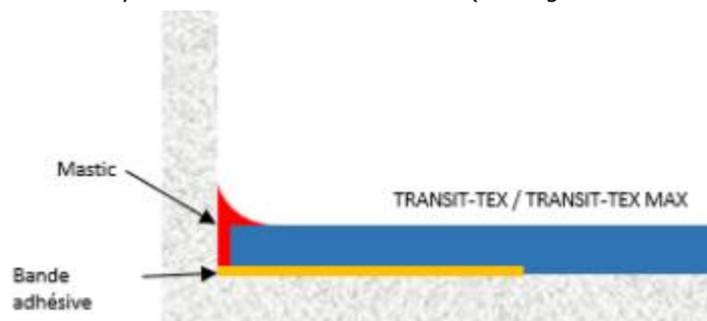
Traitement des rives en locaux E2 sur dalles vinyle-amiante
